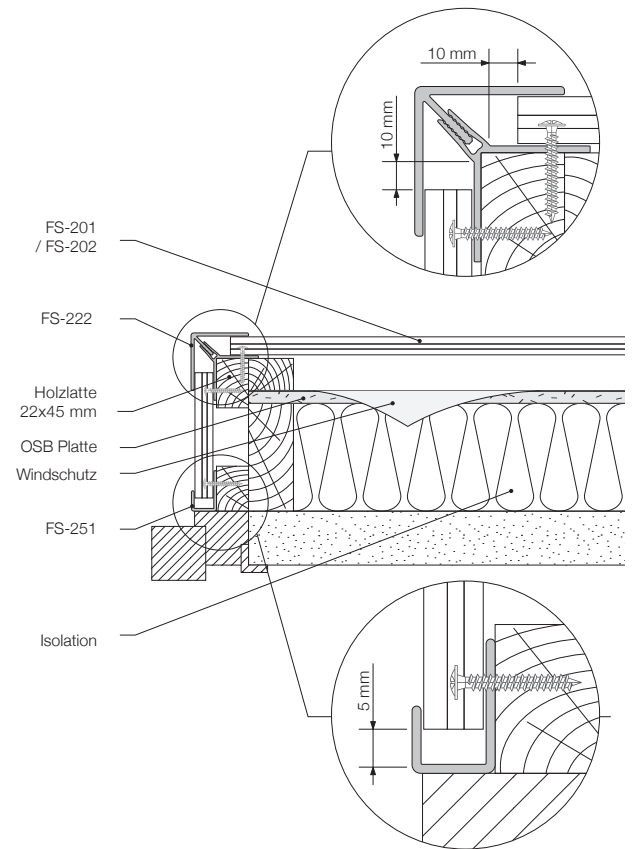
KERRAFRONT Detail, Ecke, Holzelemente an der Gerüstkonstruktion – horizontaler Schnitt
